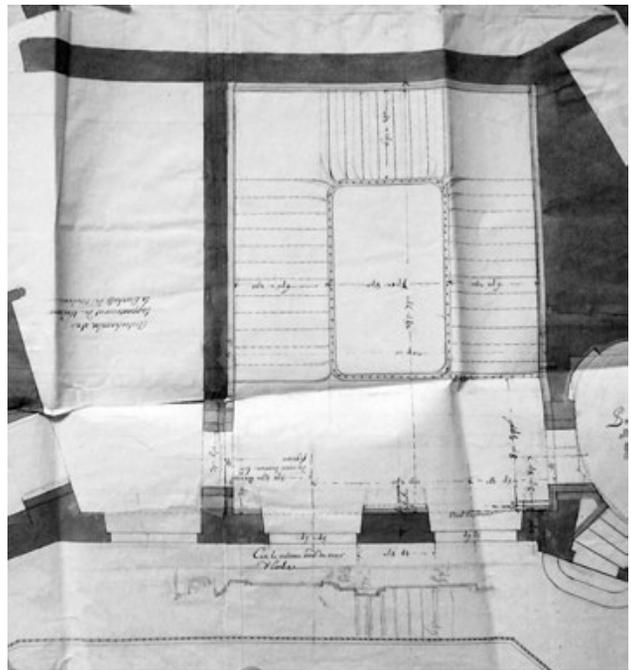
Ange-Jacques Gabriel, pianta dei lavori per la realizzazione dell'escalier du roi, primo piano, 1749, Parigi, Archives Nationales, O1 – 1422 – 78 (foto Patrick Ponsot).
